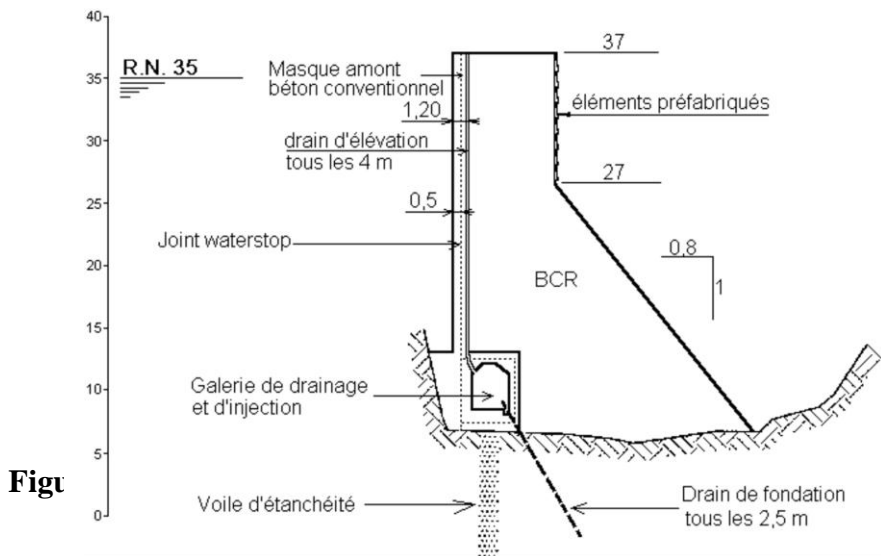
Coupe transversale d'un barrage poids en BCR.
